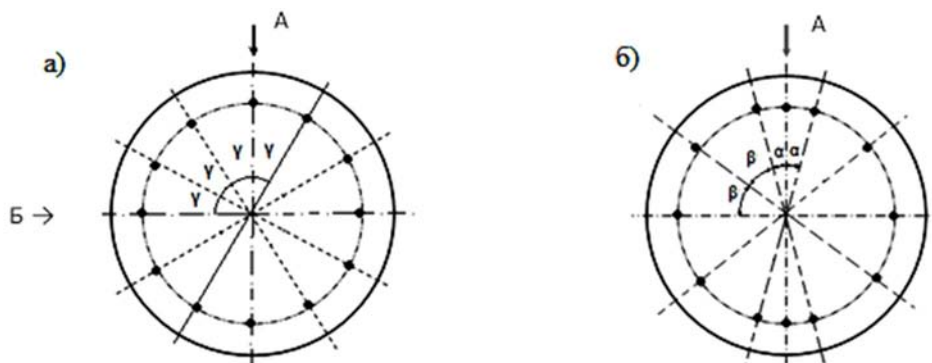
Поперечное сечение сваи с различным размещением арматуры:
